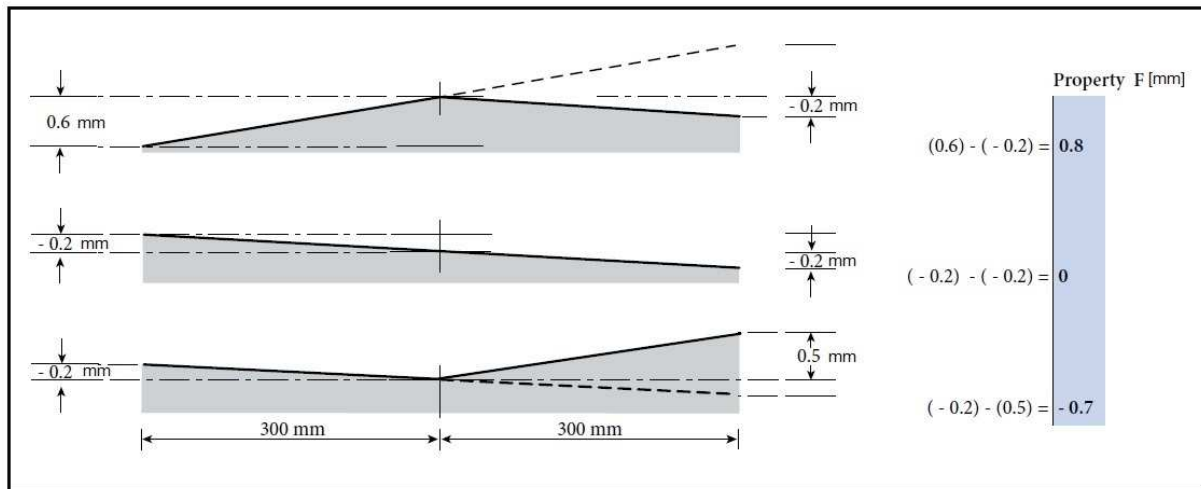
Exemplos de cálculo da propriedade F (Concrete Society, 2014)
